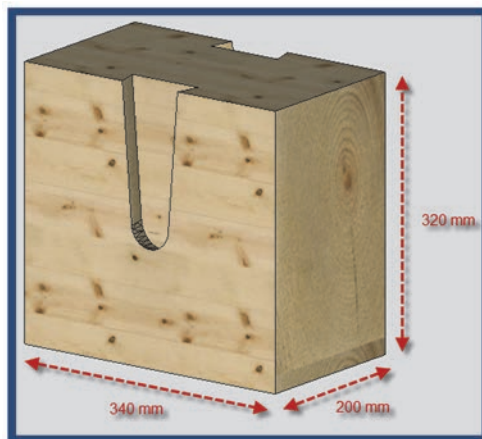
Probeta de madera laminada de píce de sección de viga con mortajas talladas que reciben a las viguetas (diseño CAD)
